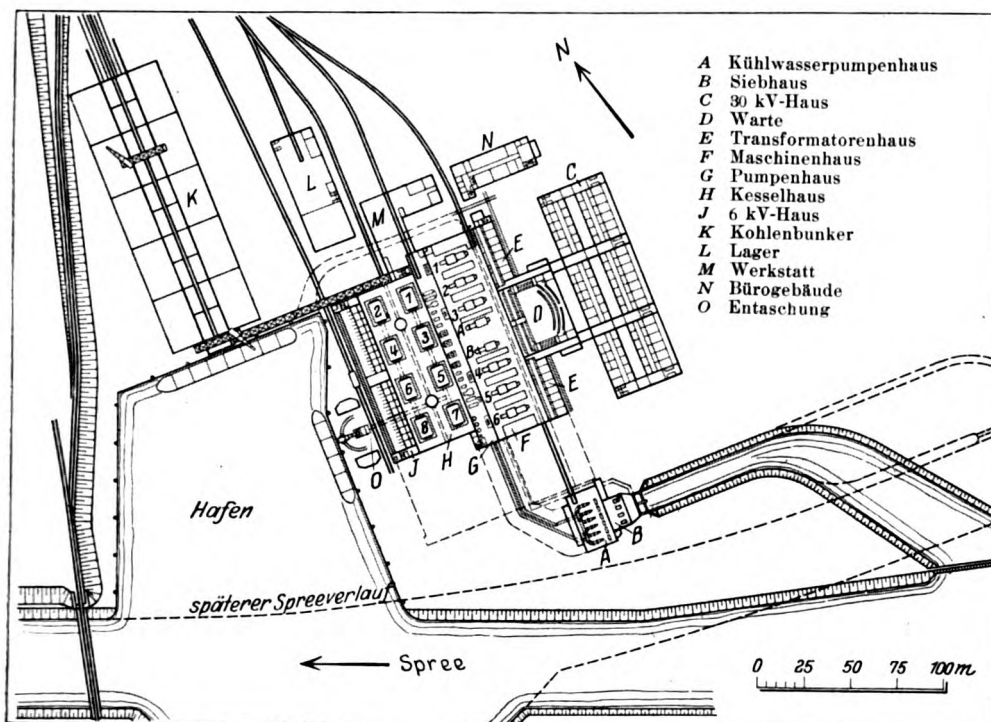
Lageplan des Kraftwerks West, Berlin.
